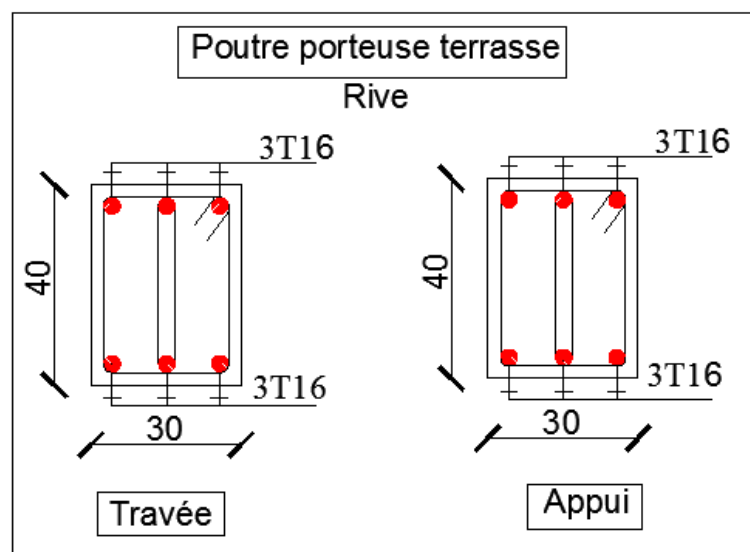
Ferrailage des poutres principales (30\*40) de rive du niveau terrasse.
